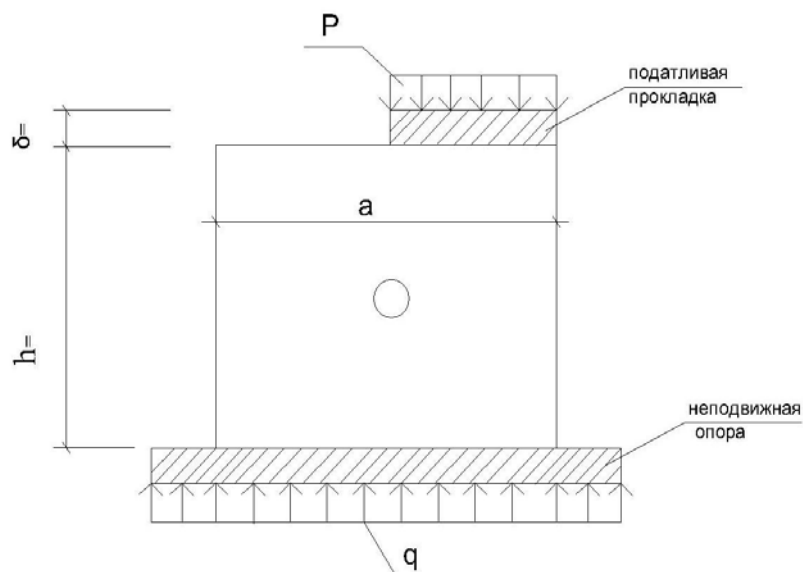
Схема испытания и расчетная схема распределения усилий по жесткому покрытию дорог.
